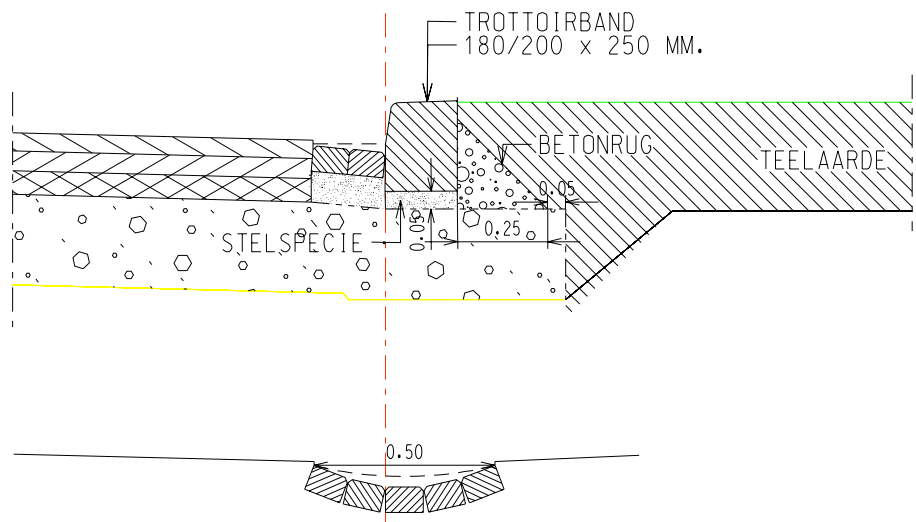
DETAIL GOOTCONSTRUCTIE 5-STREKKEN.
